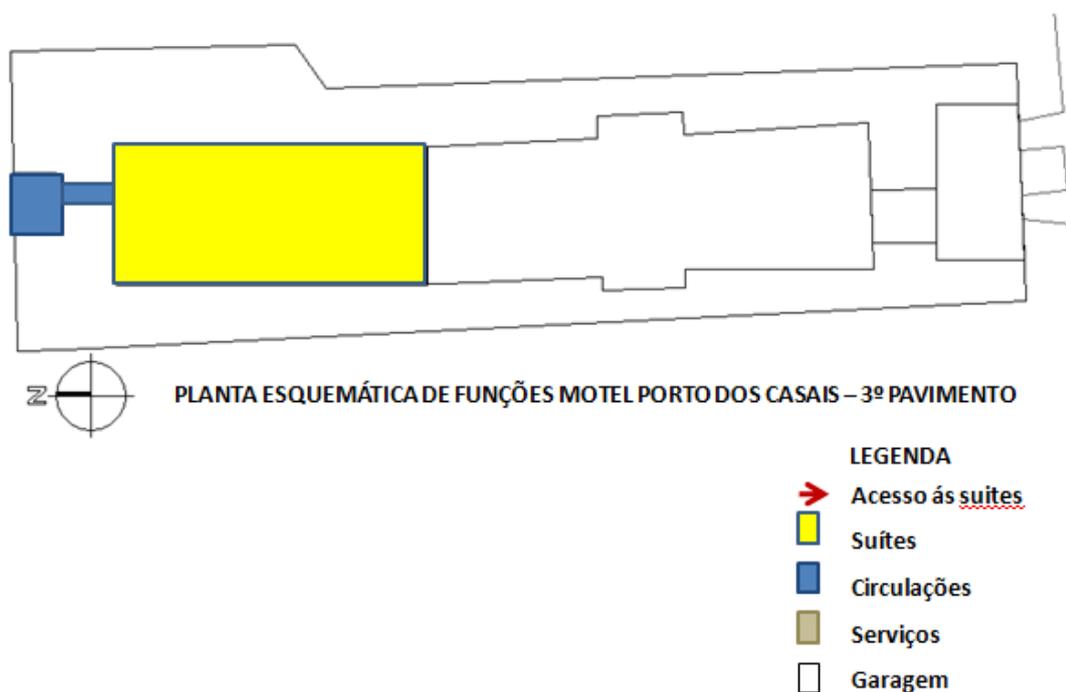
Planta esquemática de funções do 3º pavimento (AUTORA, 2010).
